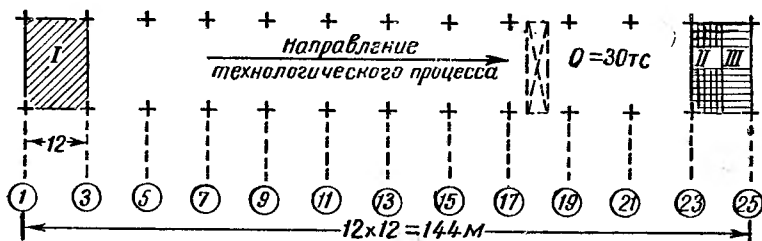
Принципиальная схема планировки унифицированного типового пролета УТП-1 для производства сборного железобетона
